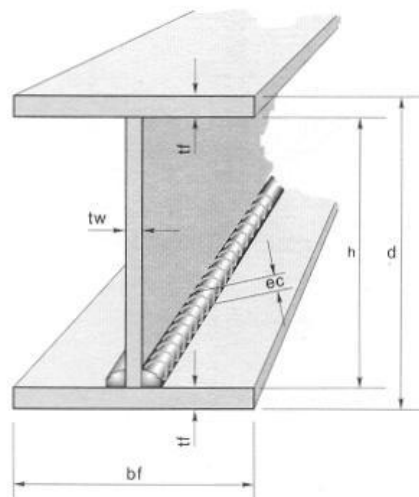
Características geométricas do perfil (Estruturas Metálicas - Notas de Aula, Instituto Metodista Bennett).
